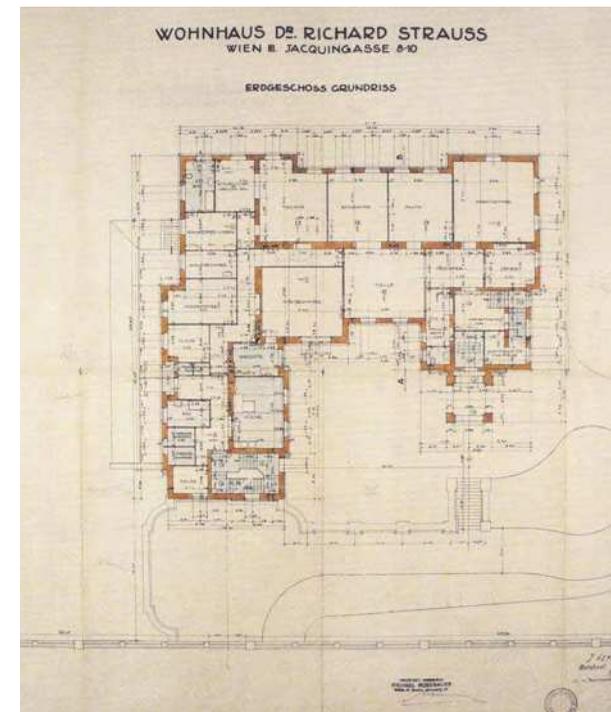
Grundriss Erdgeschoß Villa Strauss
